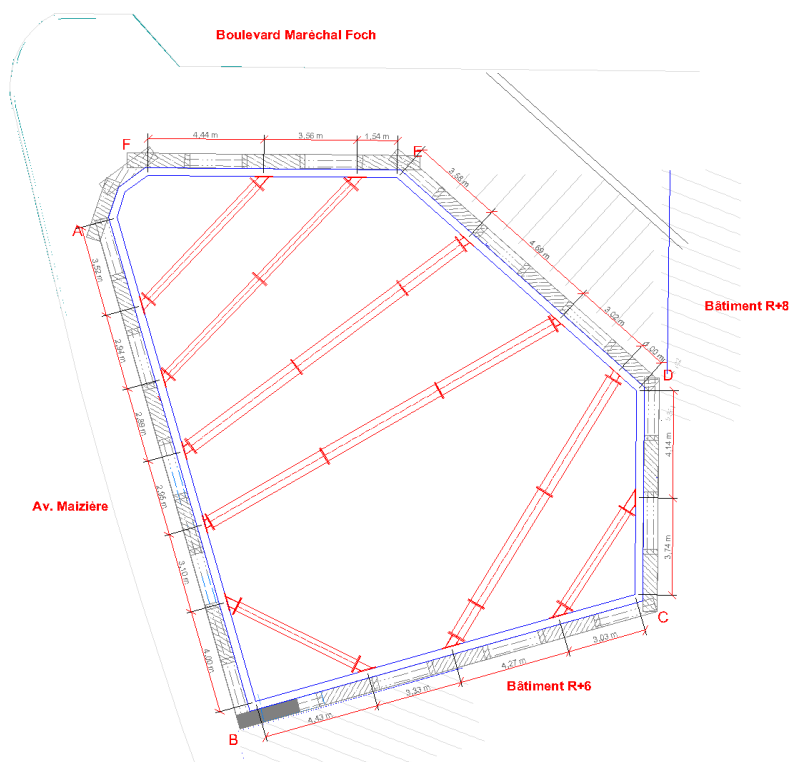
Planta da estrutura da contenção e escoramento horizontal
